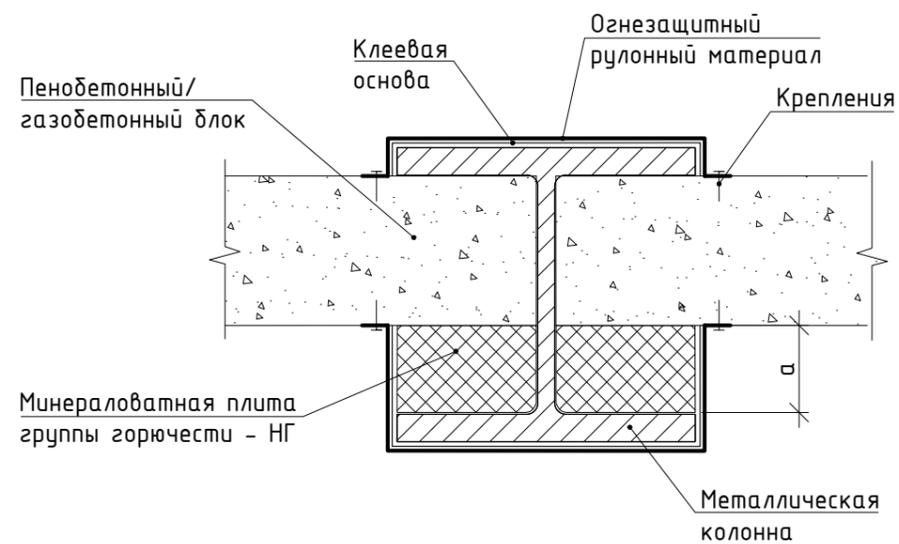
Огнезащита рулонными материалами металлической колонны, в составе стены из пенобетонных/газобетонных блоков (если расстояние "а" не позволяет смонтировать рулонный материал на открытую часть колонны, то необходимо заполнить зазор между колонной и пенобетонным/газобетонным блоком минераловатной плитой, группы горючести - НГ. Затем закрыть торцы минераловатной плиты огнезащитным рулонным материалом)
